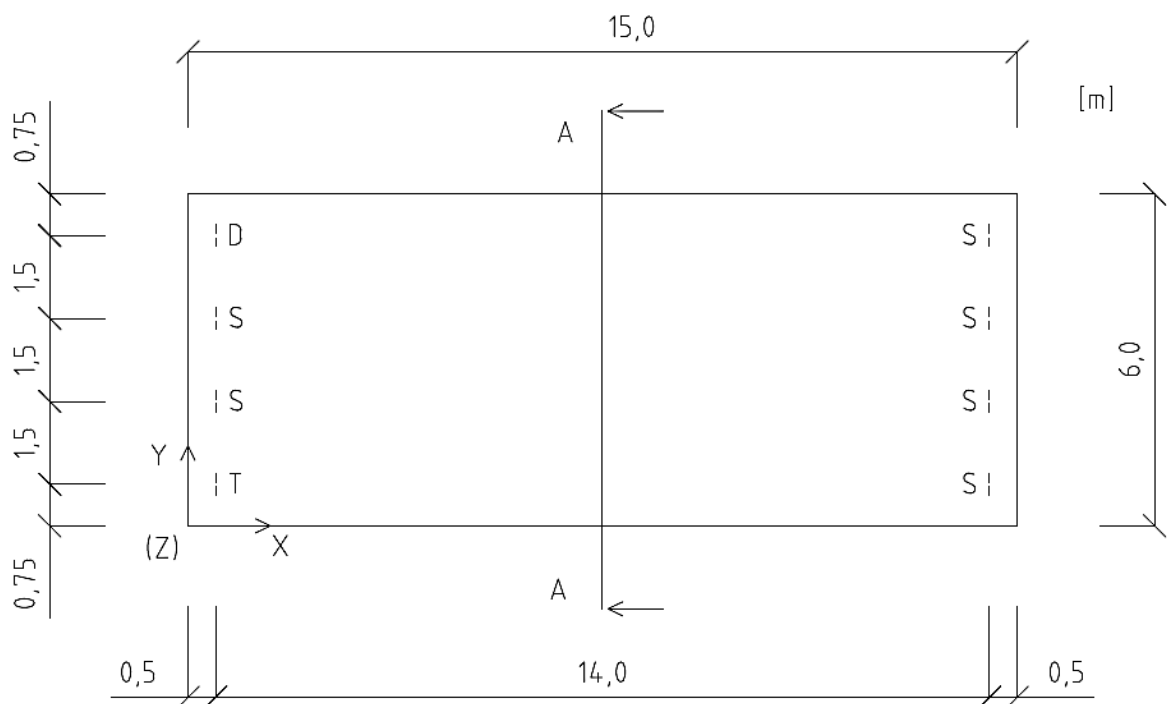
Planta da laje com localização e caracterização dos apoios pontuais
